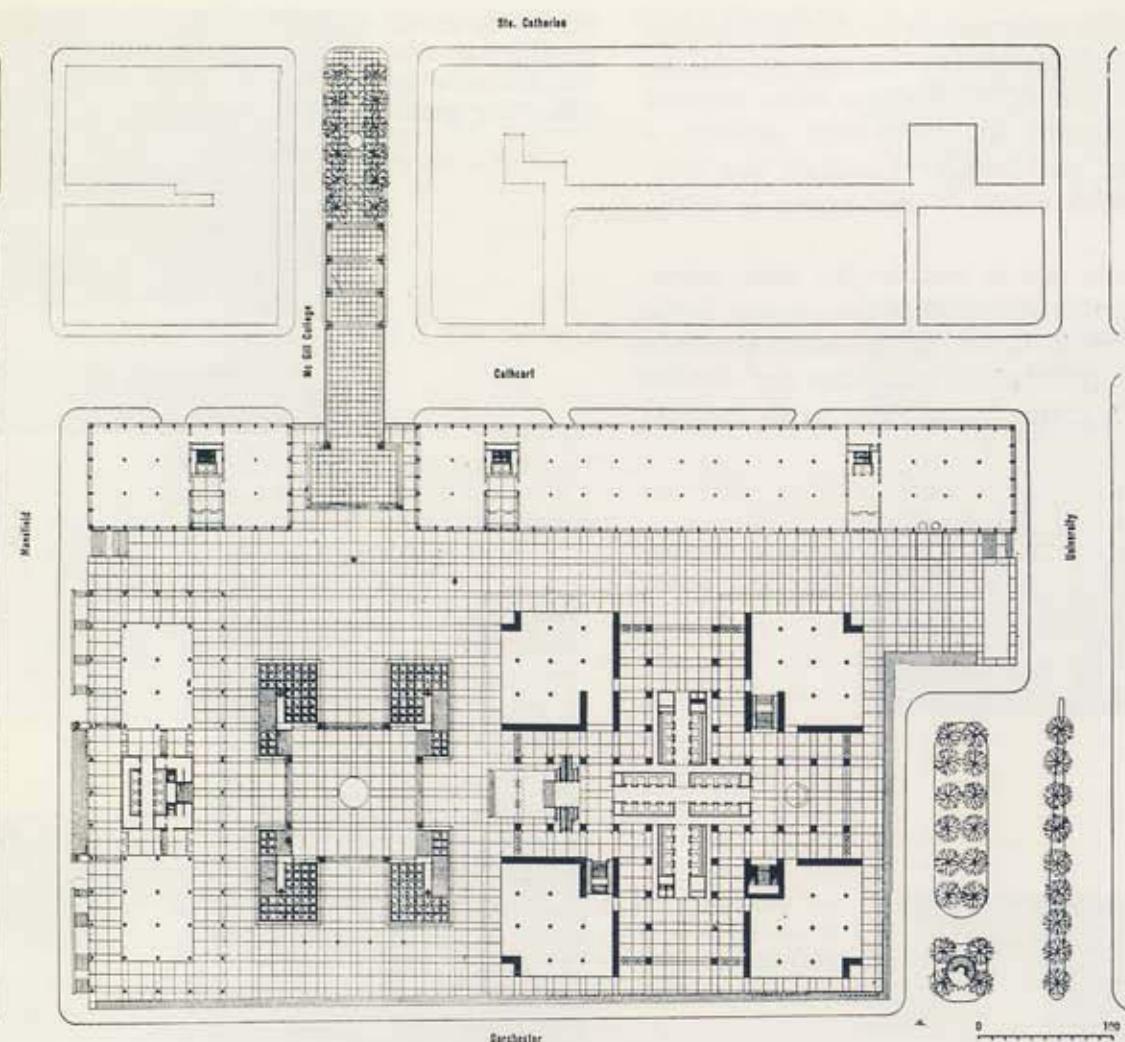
Planta do conjunto da Place Ville Marie ao nível do pavimento do largo
